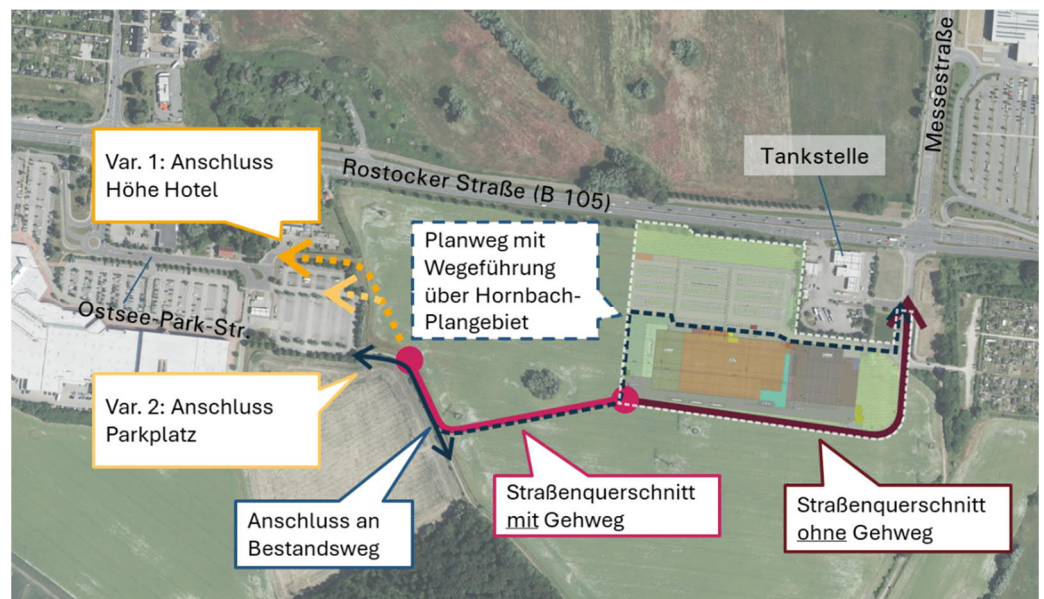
Lageplan mit Darstellung der geplanten Wegeverbindung⁷
